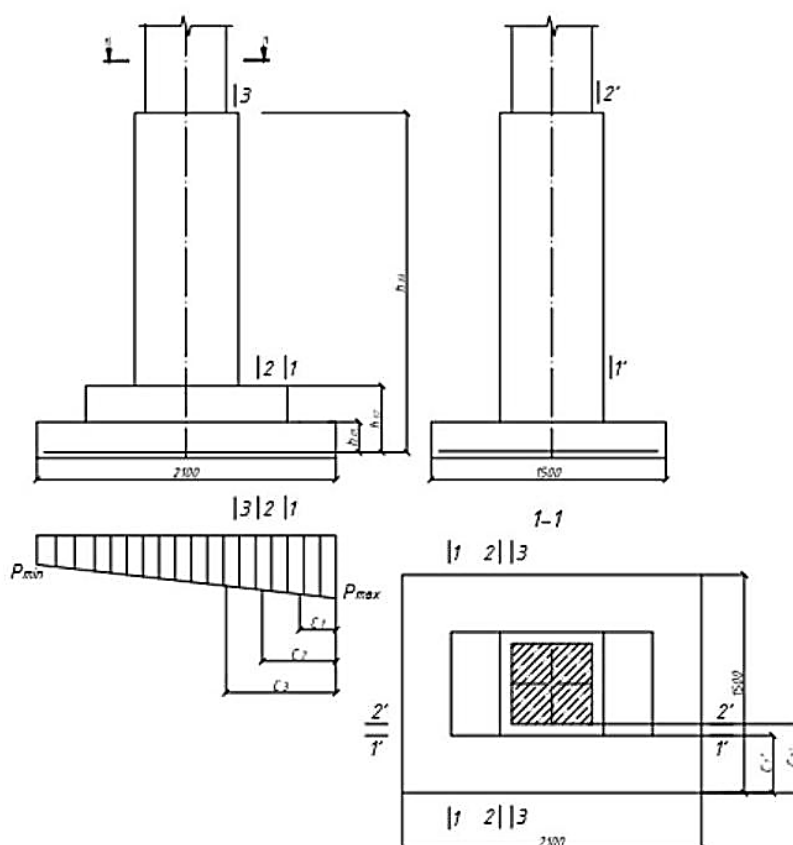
Схема розрахунку арматури плитної частини фундаменту
